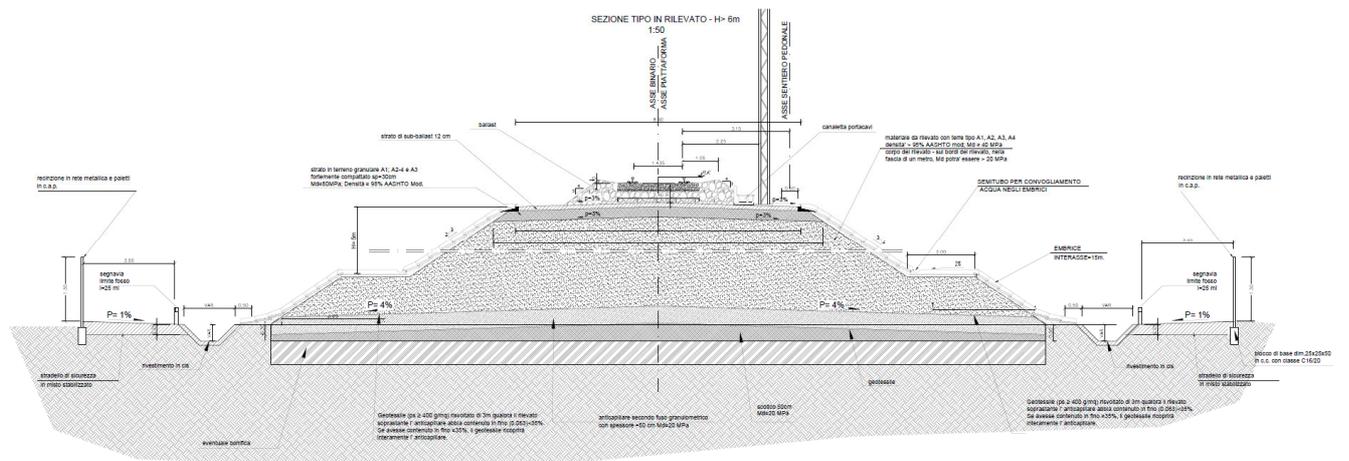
Sezione tipo in rilevato a SB, $H > 6.0$ m
